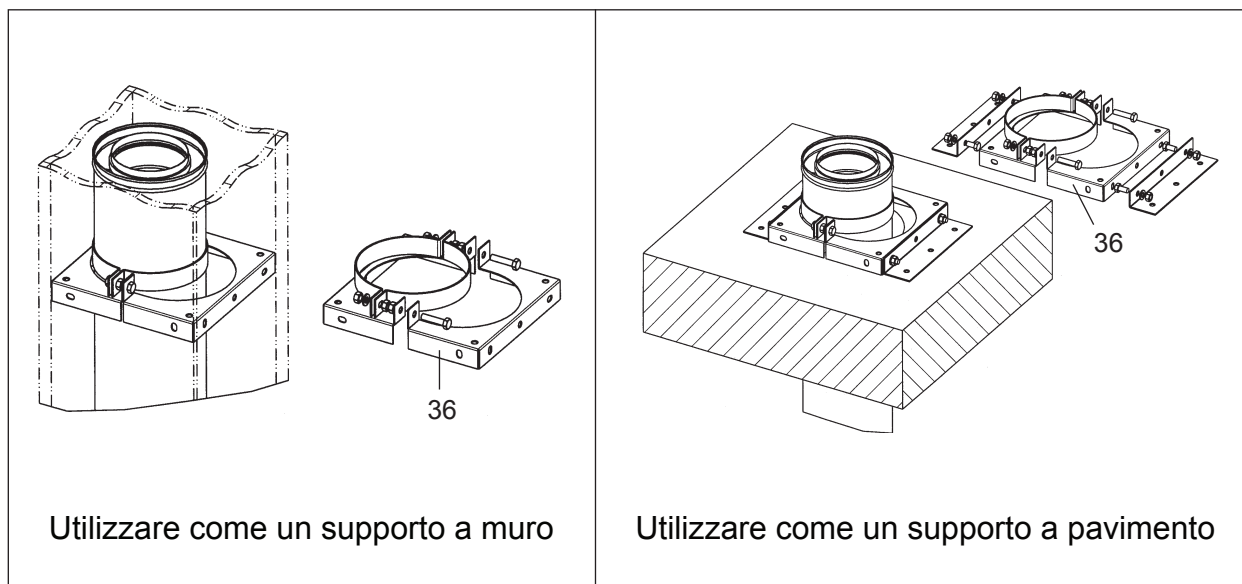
Applicazione supporto universale muro/pavimento Ø150 mm
